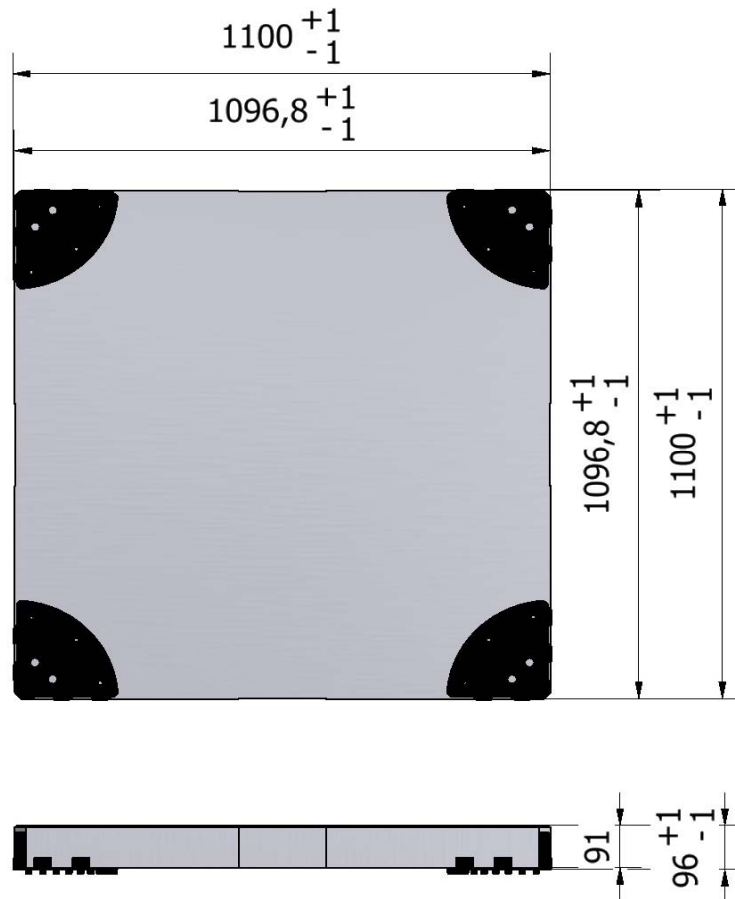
Vue de la sous-face d'une dalle Pardak® 110
